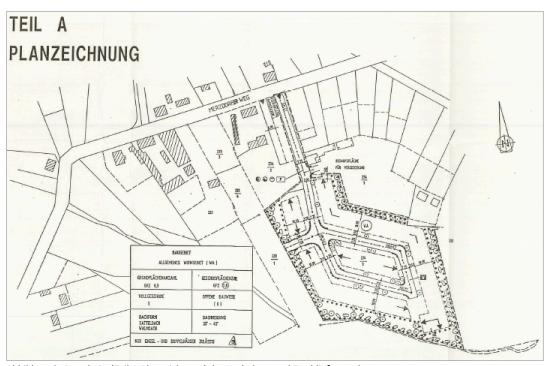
Ausschnitt (Teil A-Planzeichnung) des Vorhaben- und Erschließungsplans
